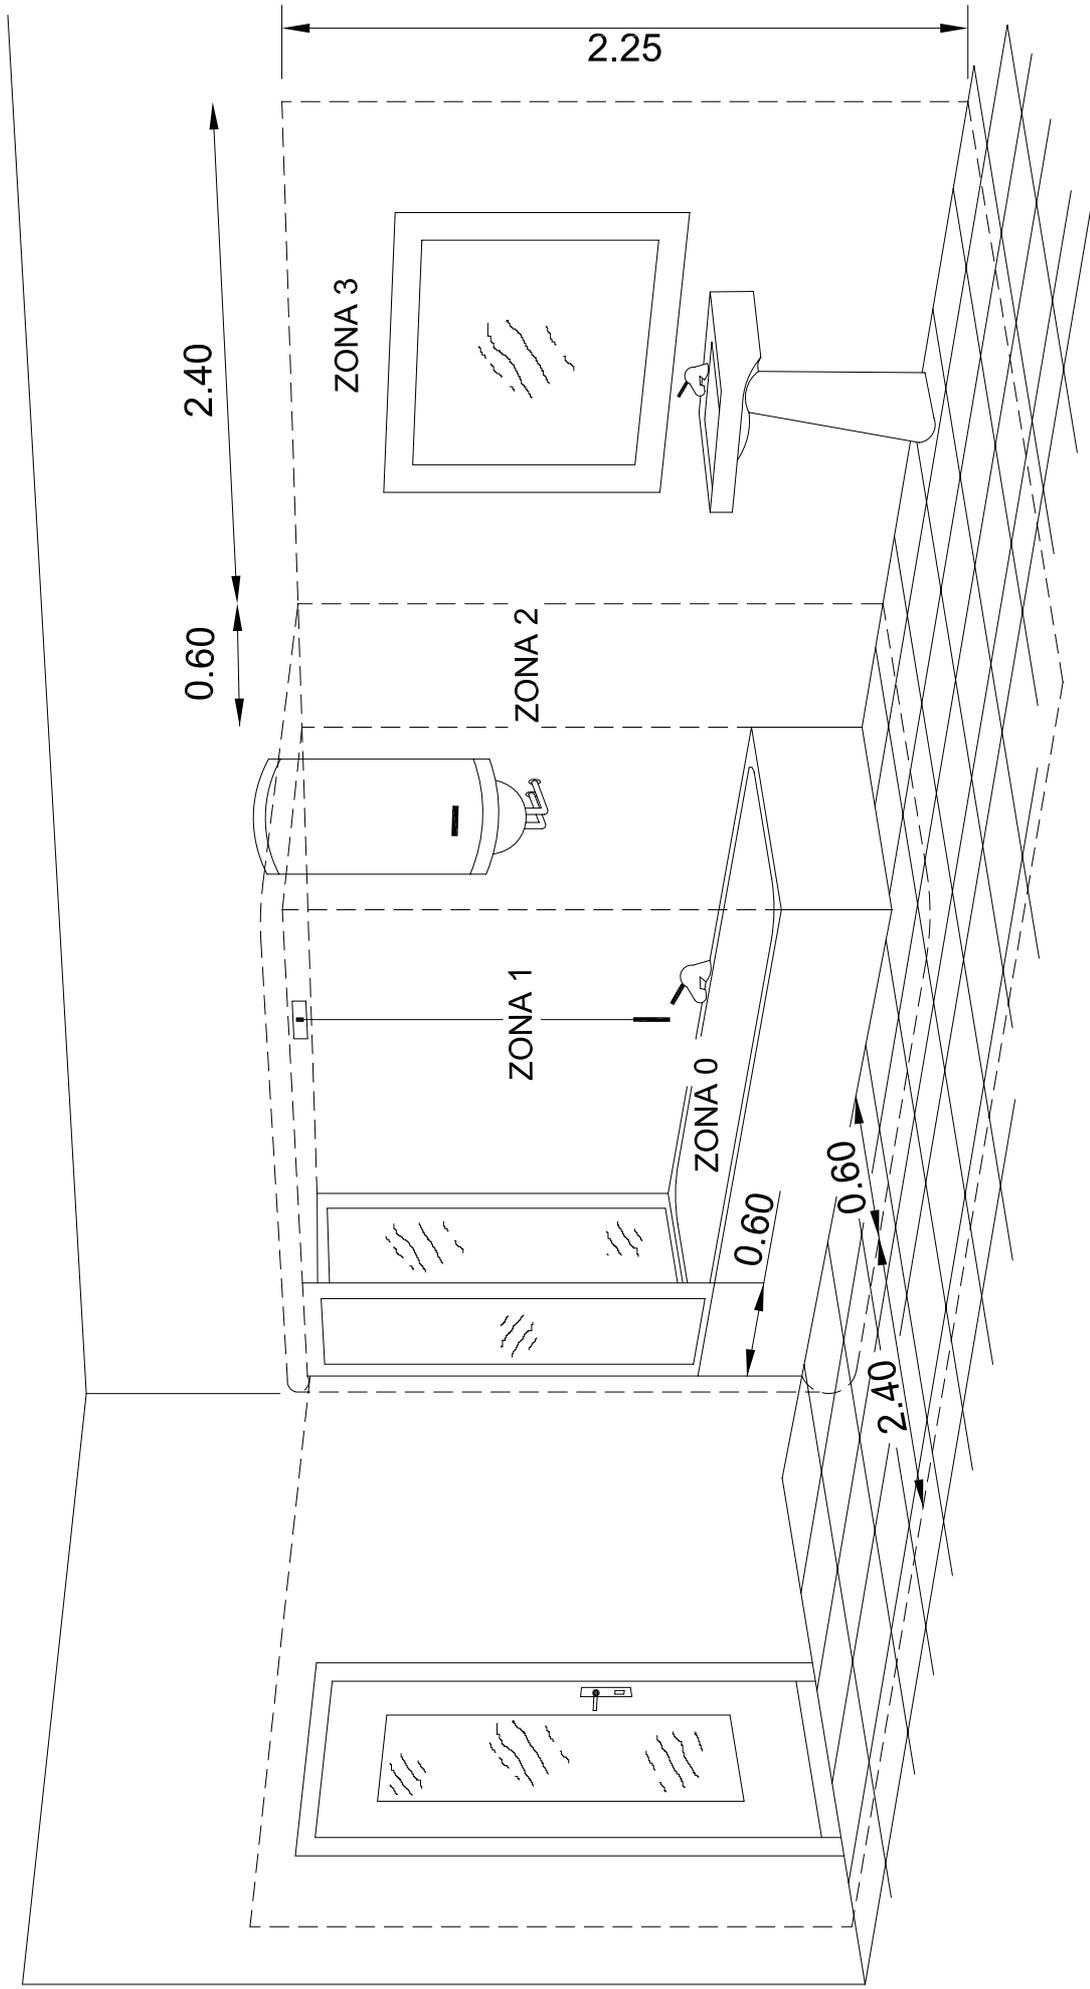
PARTICOLARE ALTEZZA DI INSTALLAZIONE PER GLI APPARECCHI DA INCASSO
